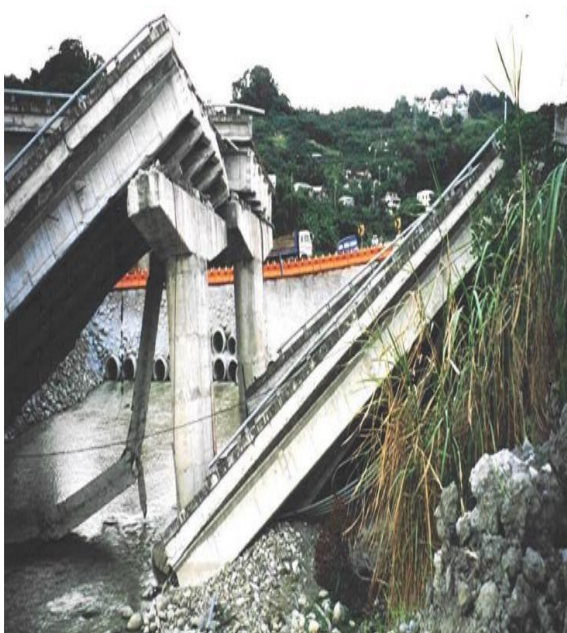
Ejemplos de daños en columnas y pilas debido a la ausencia de un detallado dúctil.
